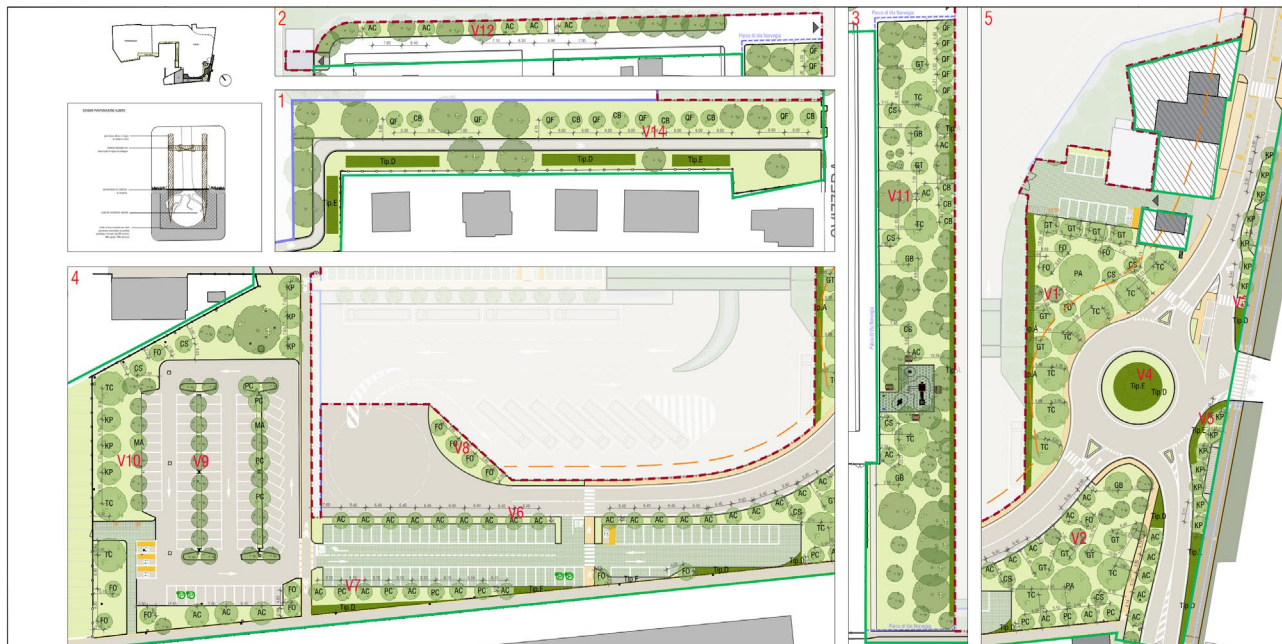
Particolari della sistemazione del verde nel lotto oggetto di intervento
